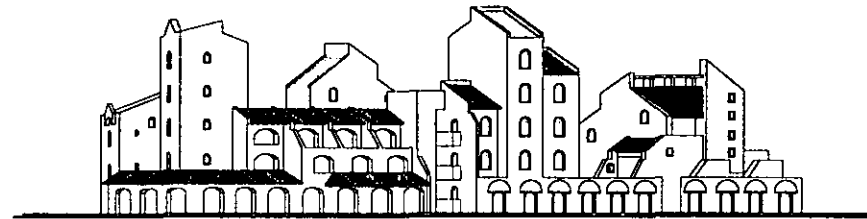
IMAGEN CON OMBRINO EN VISTA DESDE EL BOULEVAR
